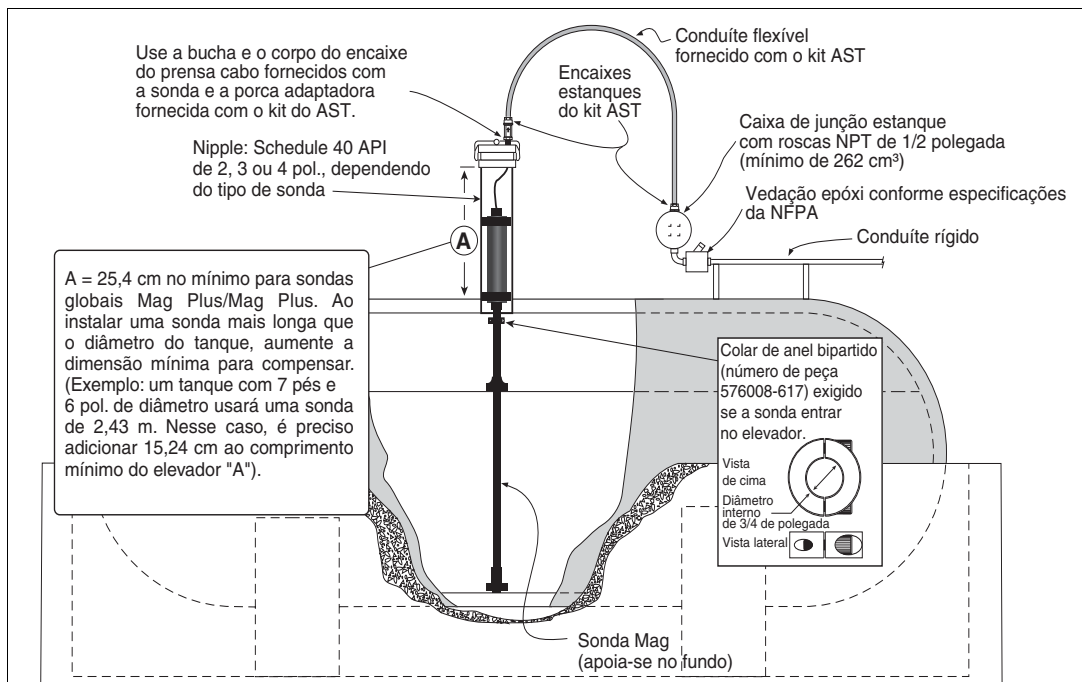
Instalação da sonda Mag Plus AST - Elevador dedicado
